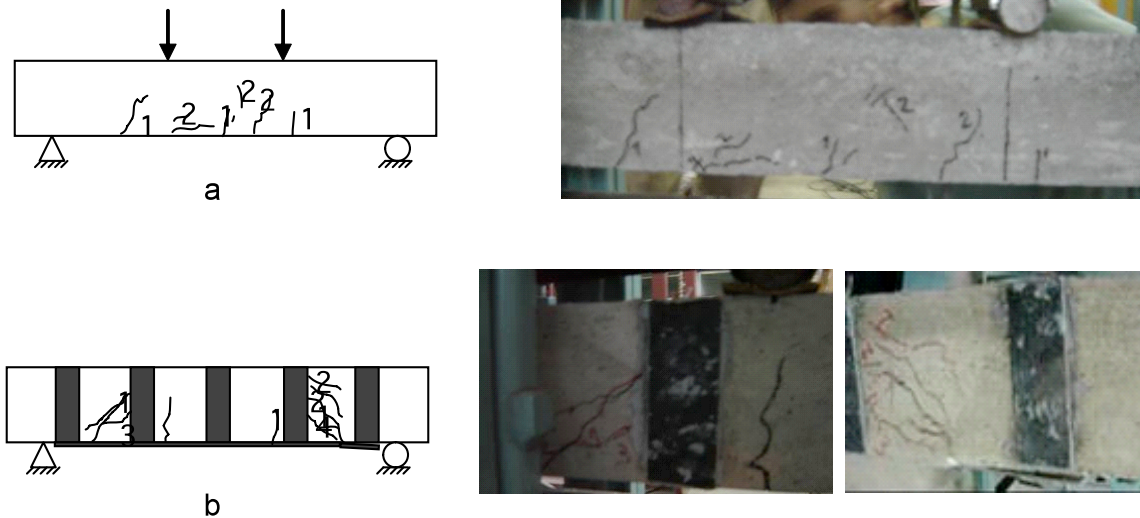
Esquema de fisuración: a) Viga de referencia; b) Viga reparada
